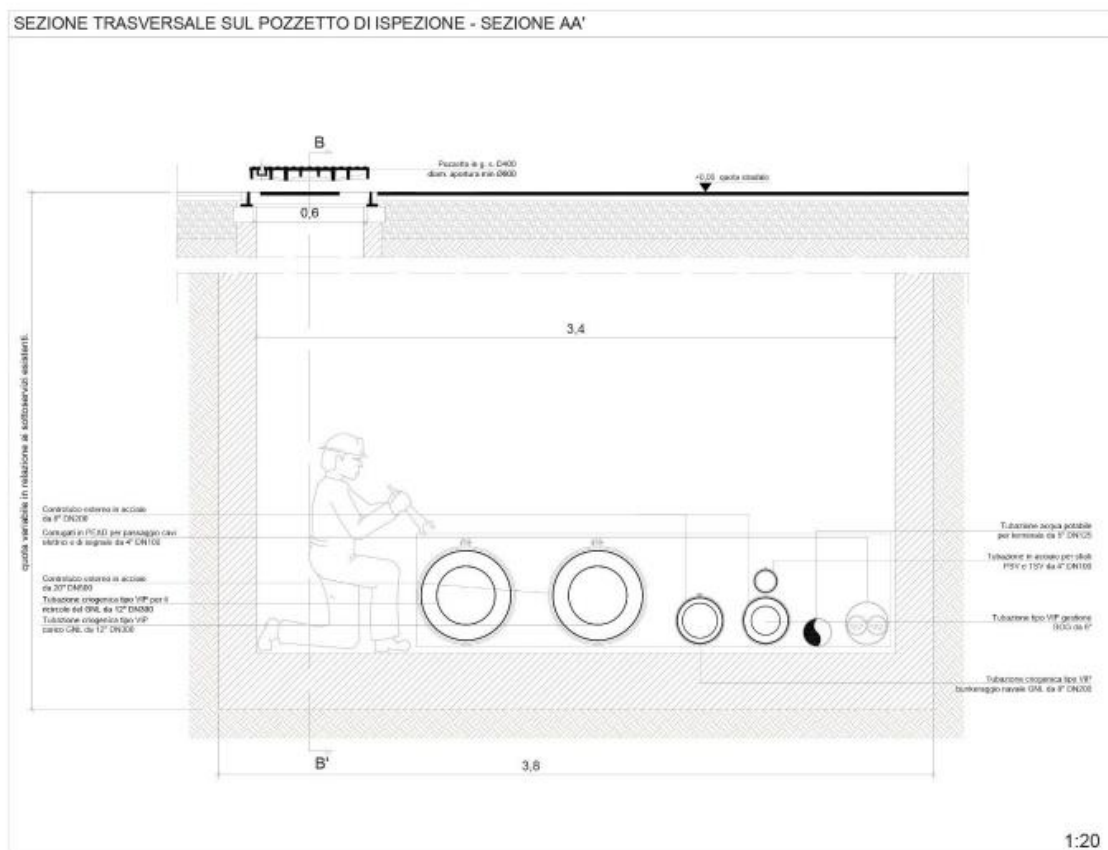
Sezione trasversale sul pozzetto di ispezione
